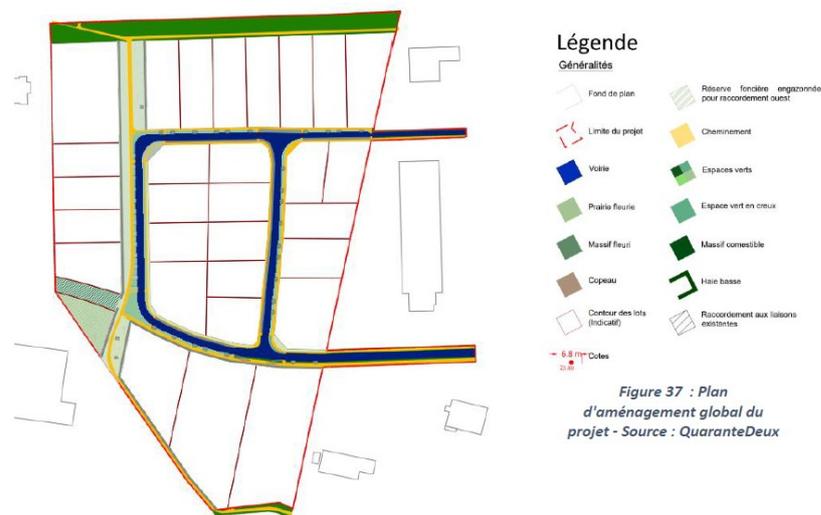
Plan d'aménagement du projet (source : p. 53 EI)
